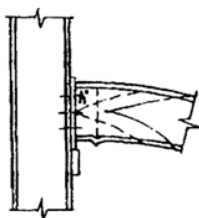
Разрушение металлической балки при смещении ее опоры
